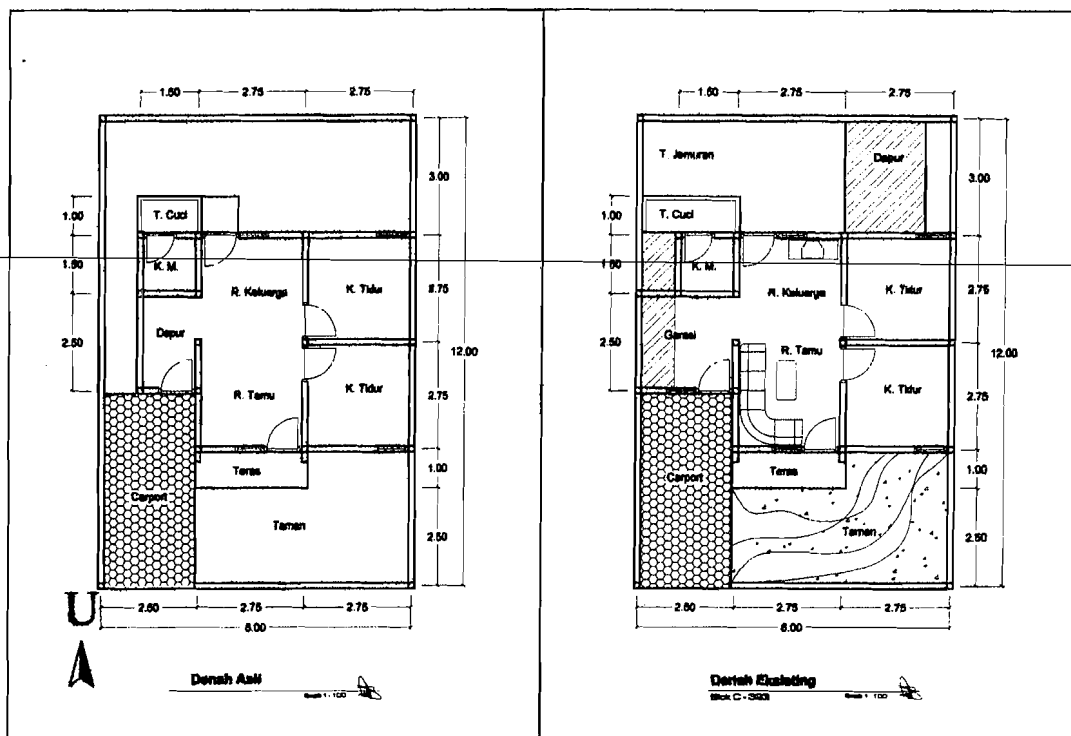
Denah Asli dan Denah Eksisting Blok C 306 yang mengalami penambahan ruang dapur dan ruang makan.
